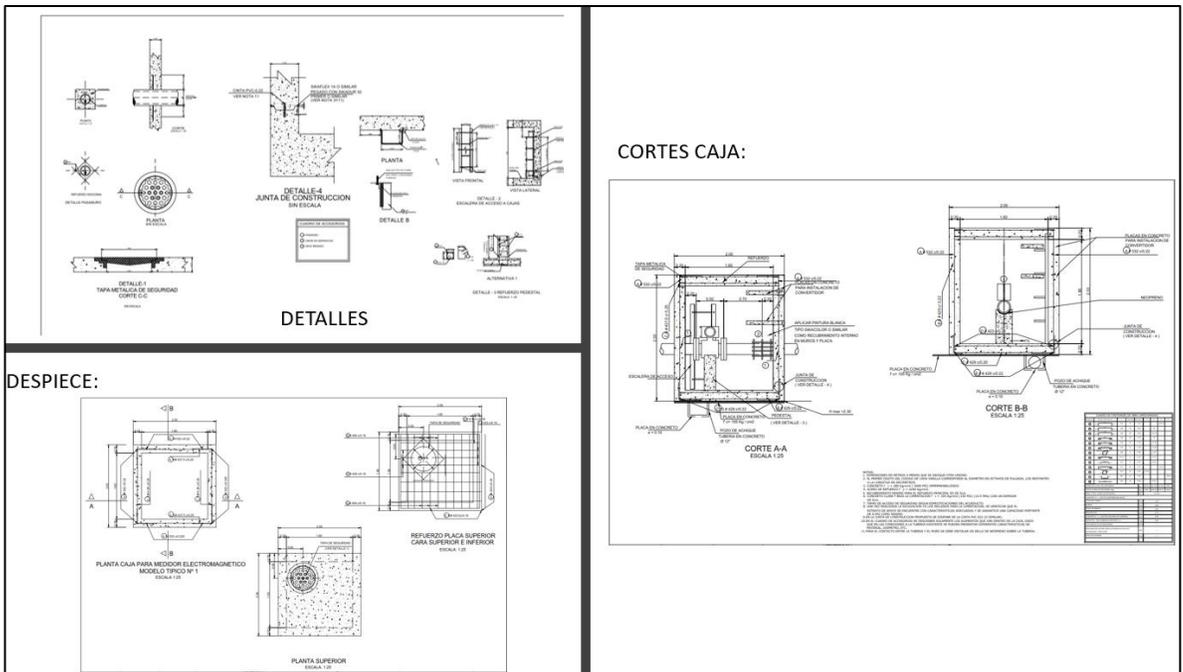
Plano Estructurales As-Built Cámara Macromedidor, Fuente: Consultor Constructor
